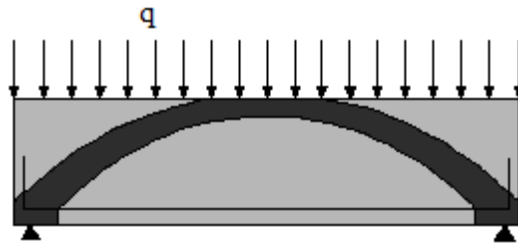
Efeito arco em vigas (adaptado de JEONG & KIM, 2014).
